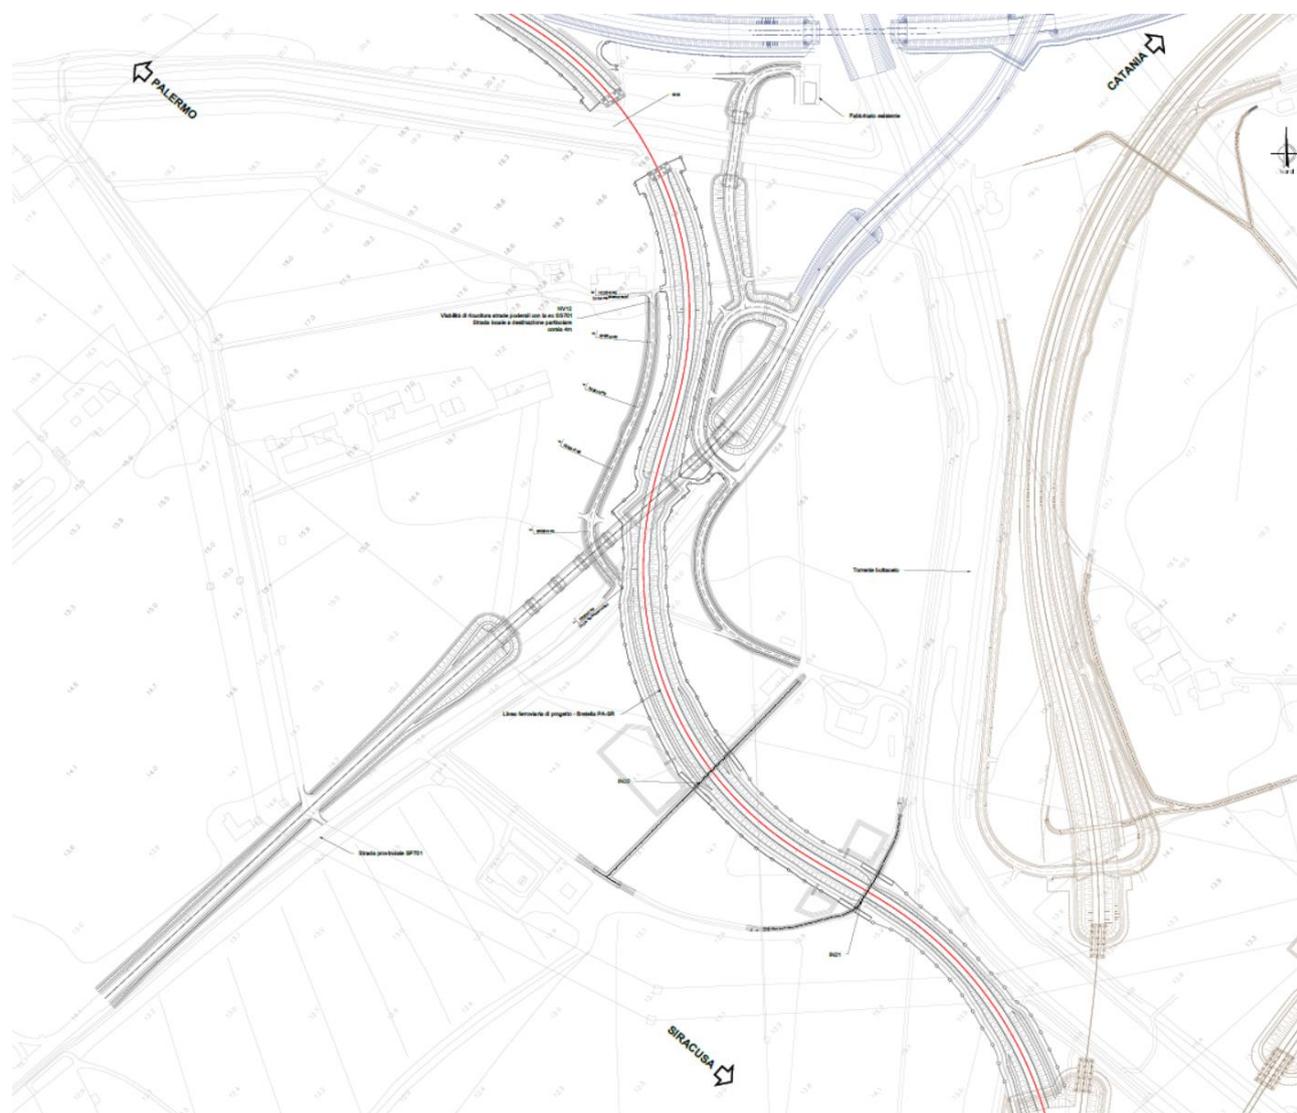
Stralcio planimetrico di progetto intervento NV12
